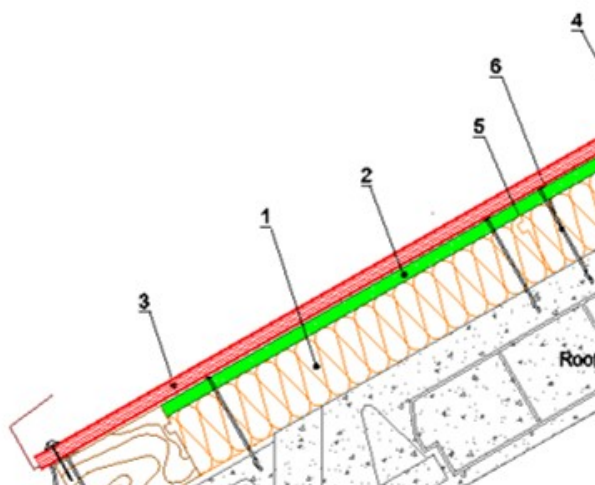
Ejemplo de SIATE instalado en cubierta de hormigón.
